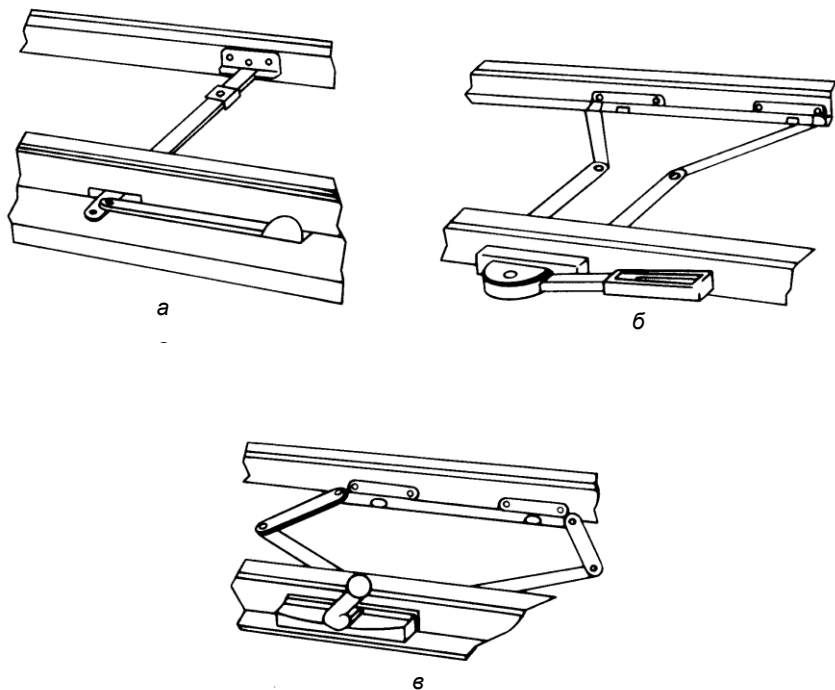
Способы закрывания створчатых окон: а — стандартный толкатель; б — рычажный замок; в — вращающий механизм (Andersen)
